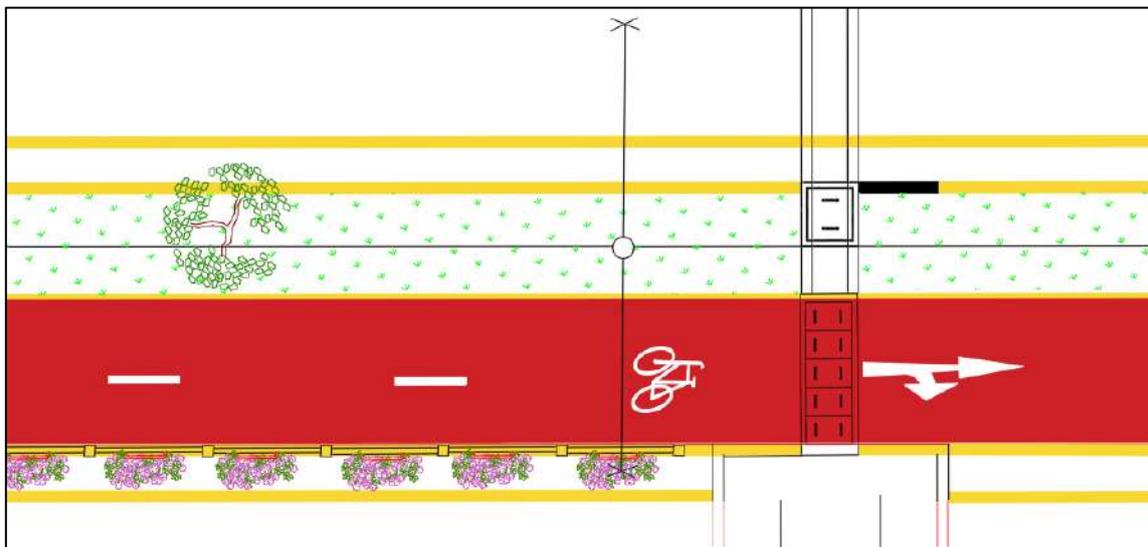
Vista en planta de la solución al obstáculo que presentaban las cunetas perpendiculares a la calzada secundaria
